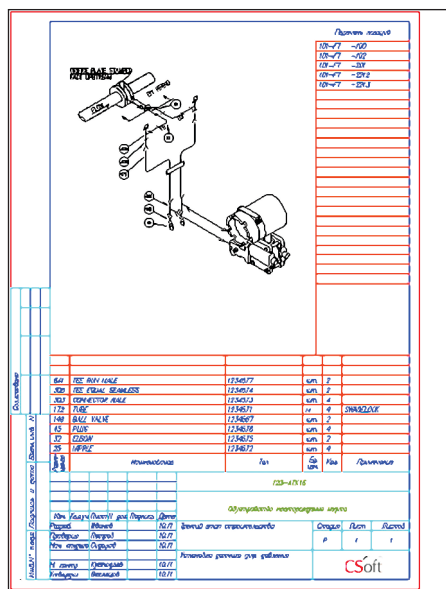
Монтажно-установочный чертеж в AutoCAD
